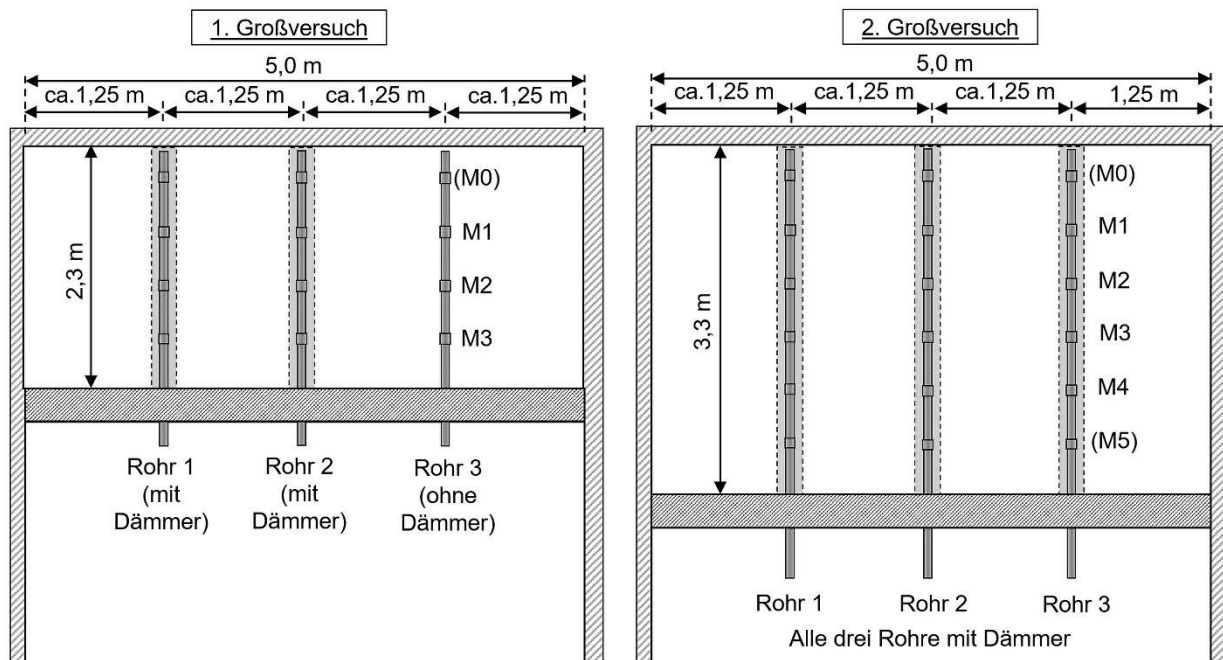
Schematischer Grundriss des Versuchsaufbaus
